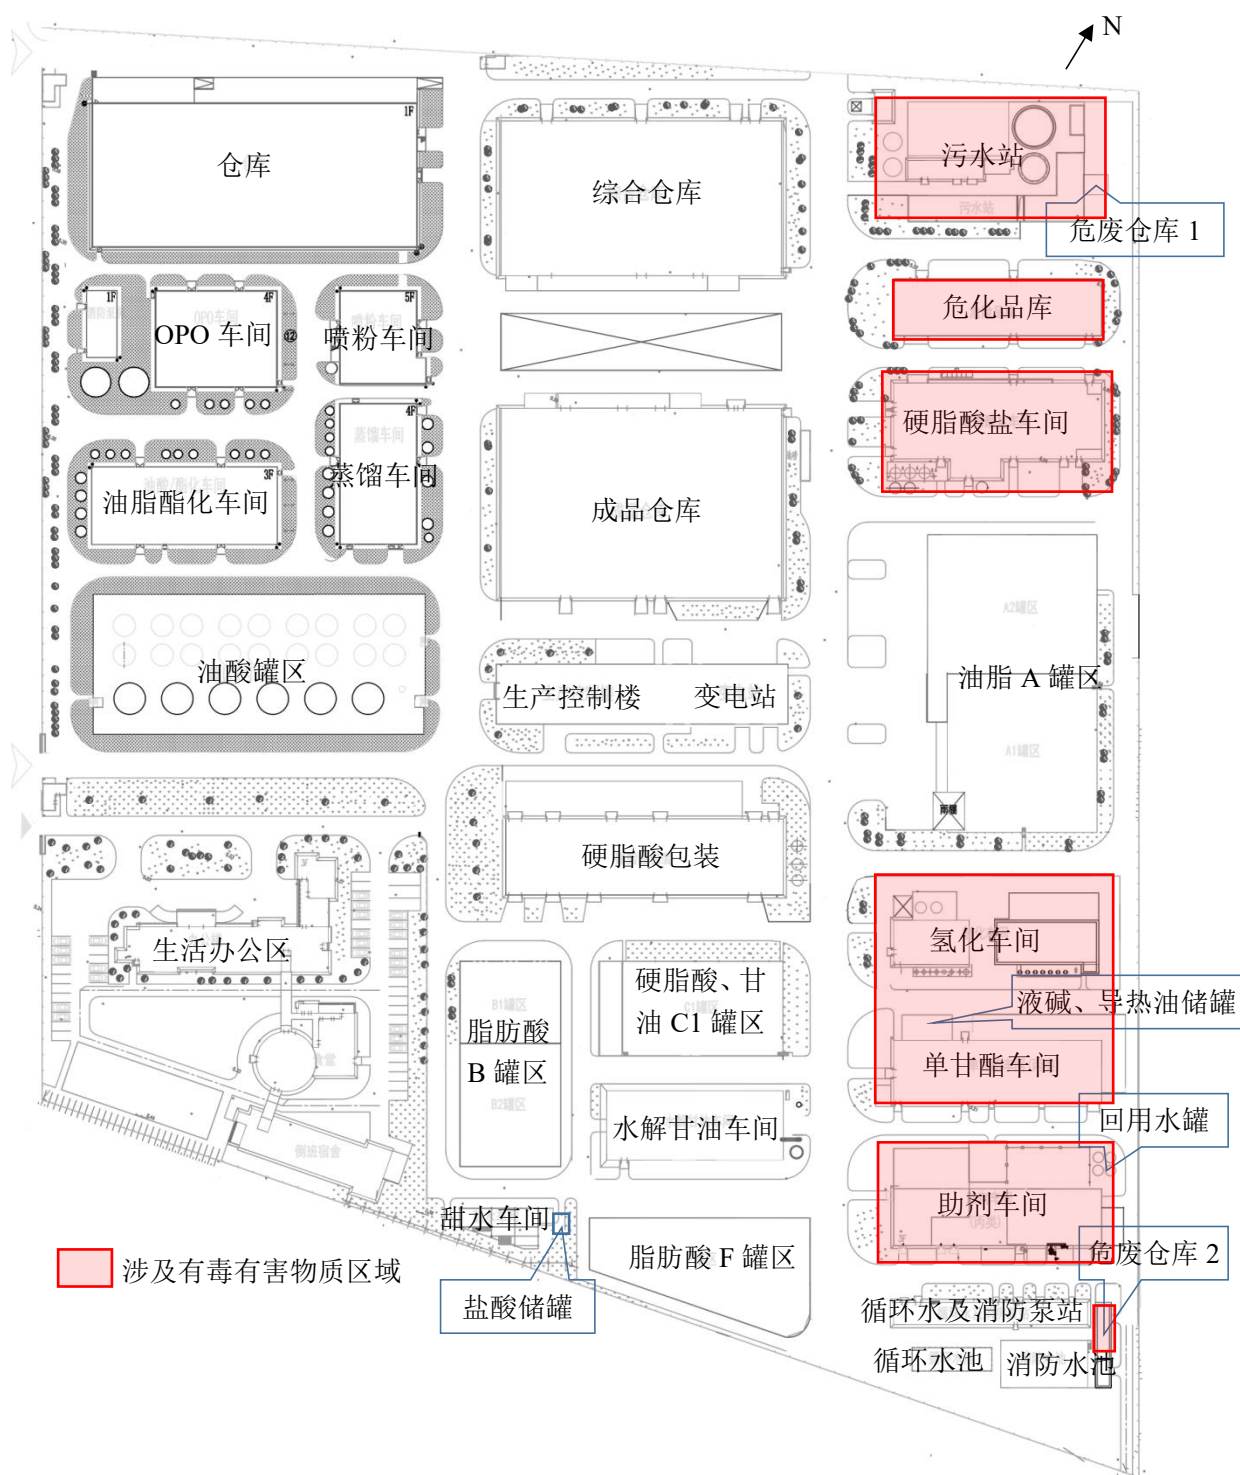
杭州赞宇油脂科技有限公司平面布置图
